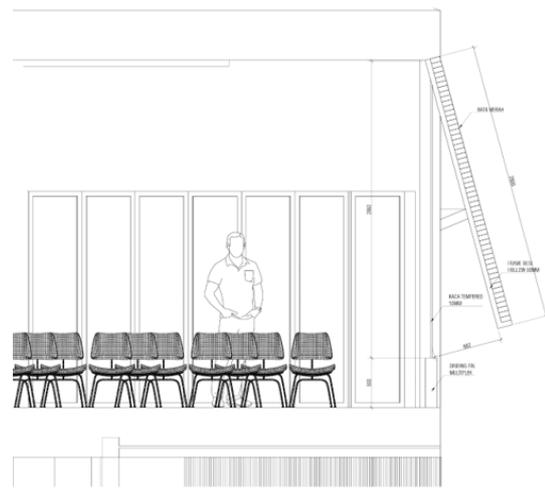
Denah dan Potongan galeri *Photovoice
